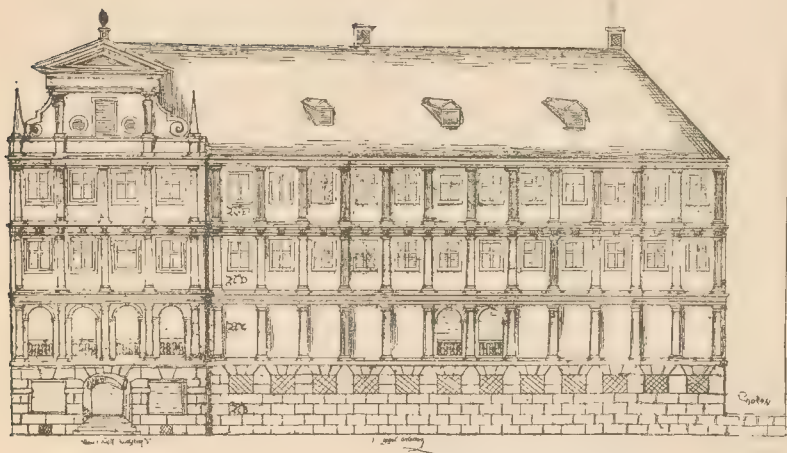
Elias Holl, Beckenhaus. Fassadenentwurf.
